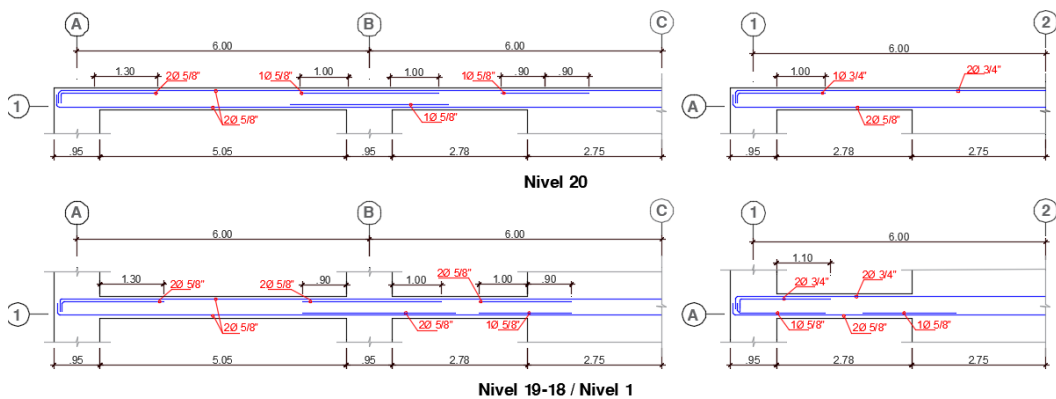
Refuerzo convencional requerido por flexión en las vigas para el edificio Edi-20
